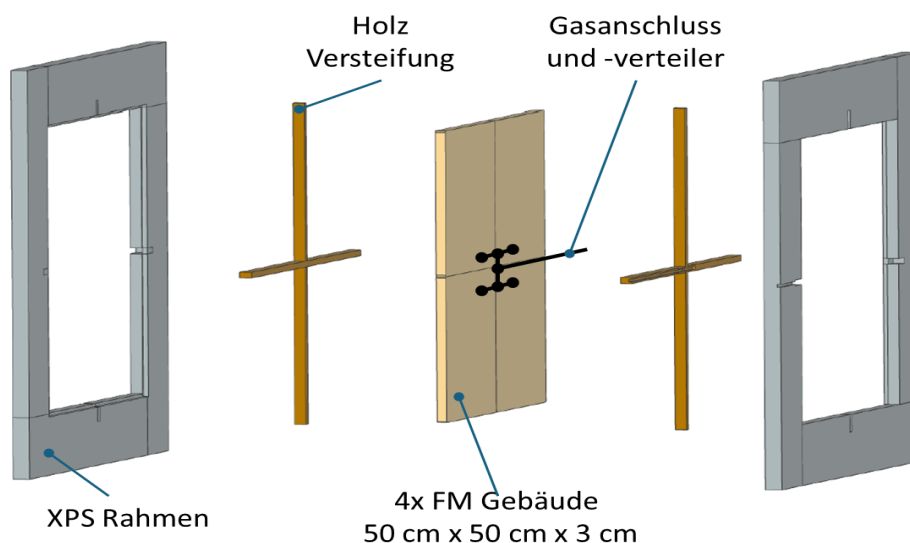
Explosionszeichnung der Fassade mit regelbaren Vakuumdämmelementen des Bauteildemonstrators
